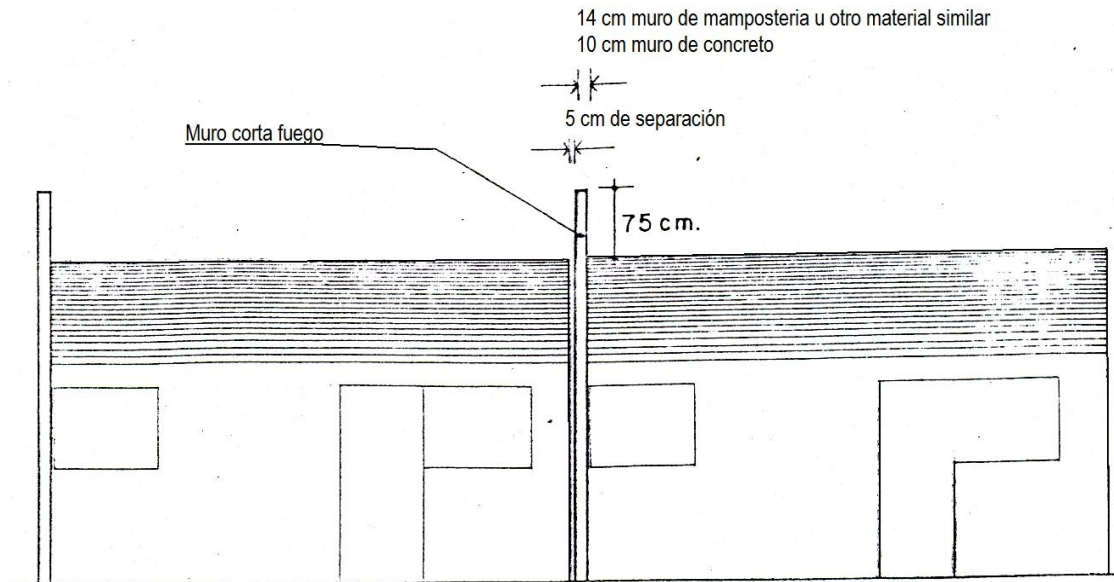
Dimensiones del muro corta fuego, vista Lateral.
